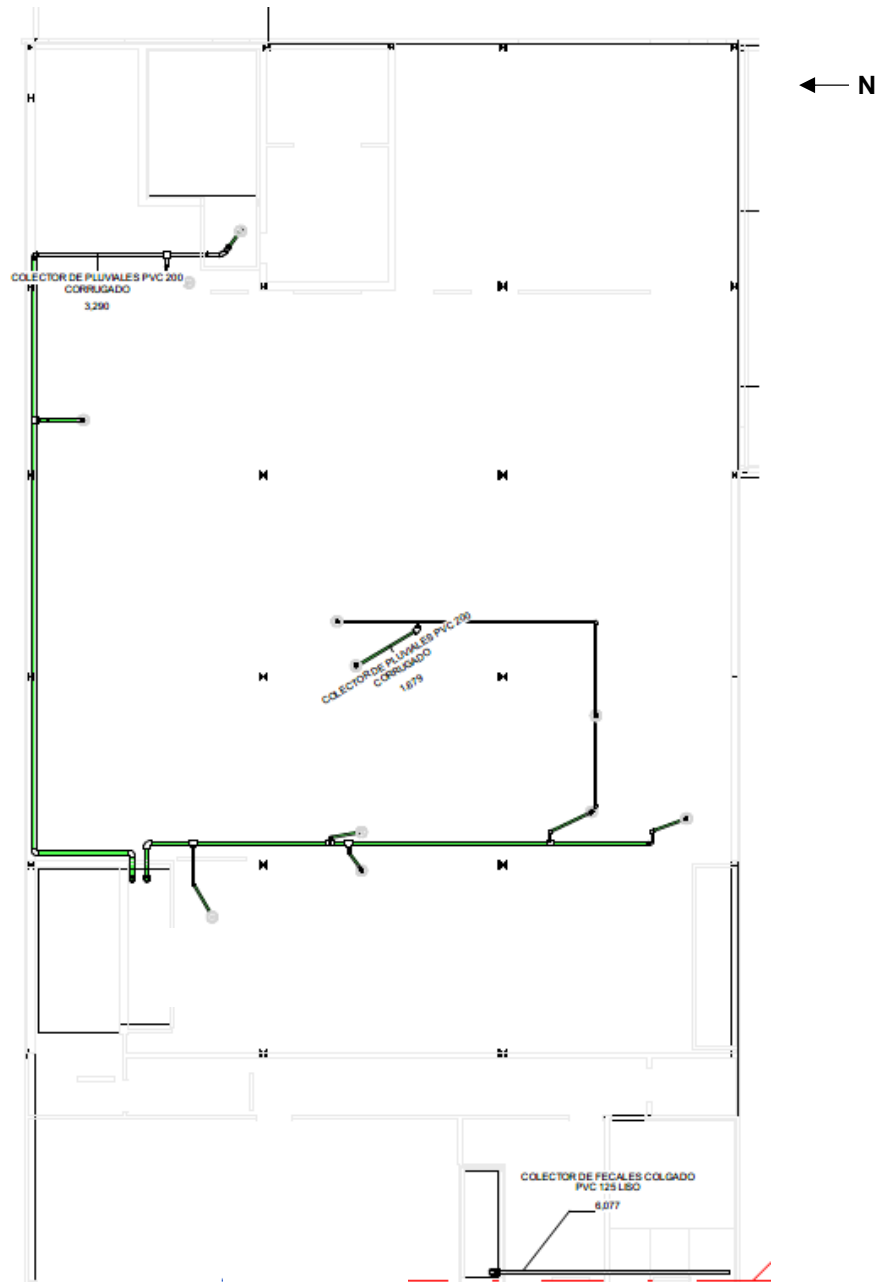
Red de saneamiento en la primera planta de la planta farmacéutica
